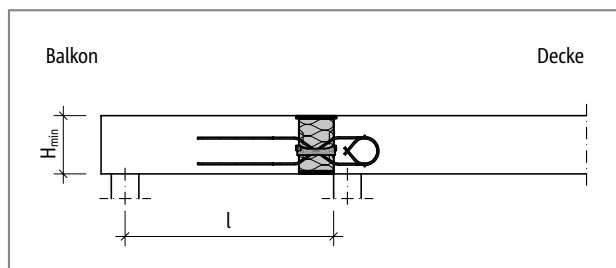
Schöck Isokorb® XT Typ QL-VV: Statisches System (XT Typ QL-VV1 bis VV4)
